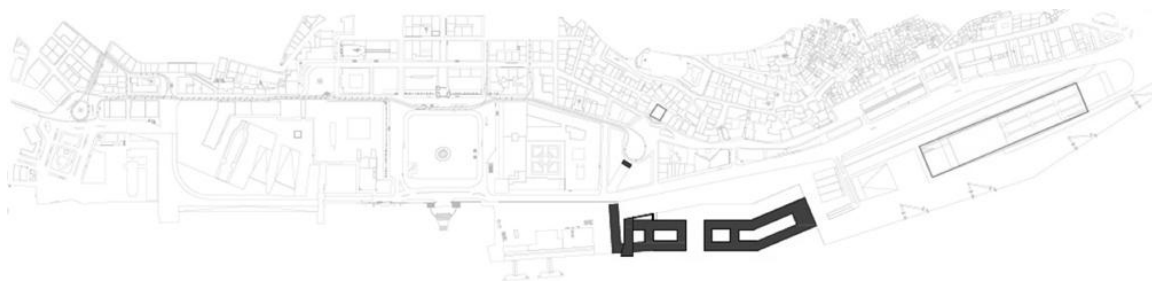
Planta de Implantação. (Ilustração nossa, 2011)
